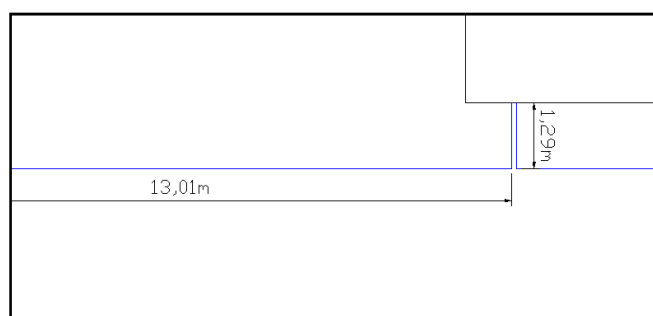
Detalle longitud conductores autocad. Alternativa 2.
